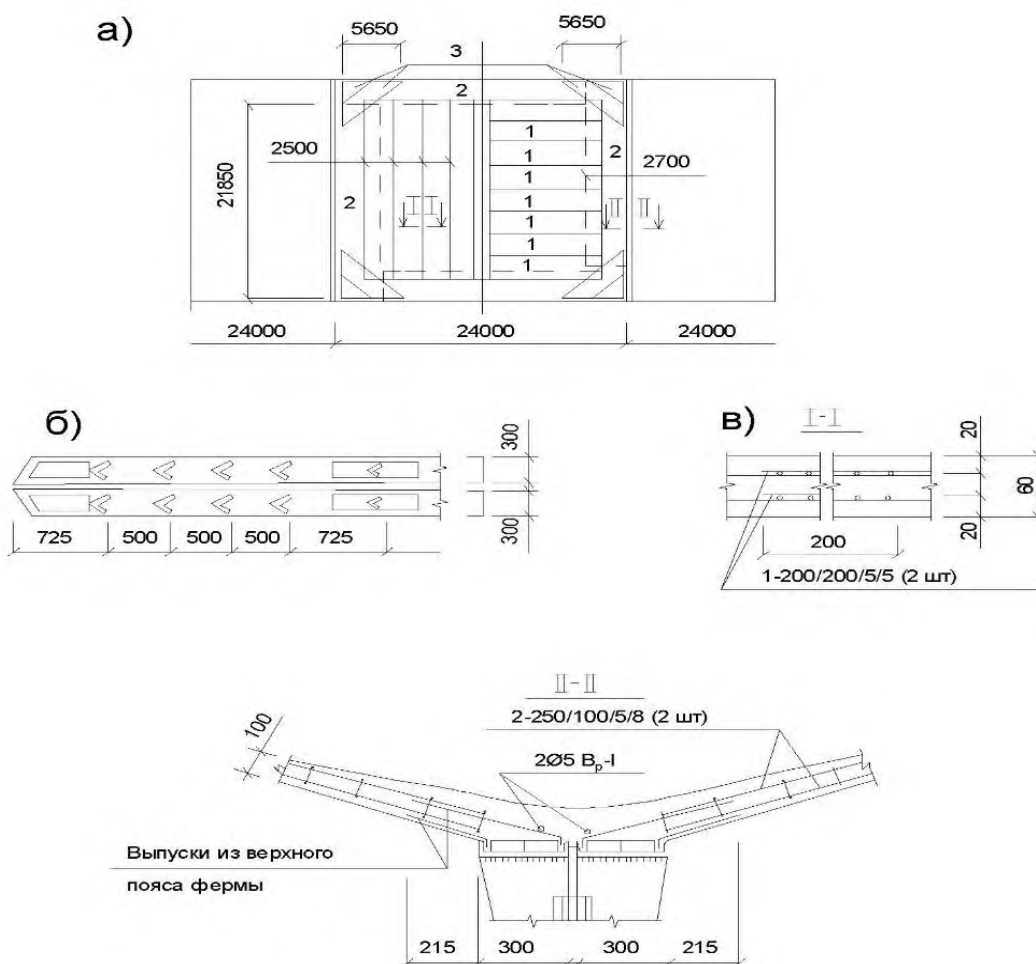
Конструкции естественных неразрезных пологих оболочек размерами 24 x 24 м каждая: а) схема армирования; б) конструкция верхнего пояса ферм –диафрагм двух смежных оболочек; в) армирование плиты поля оболочки; г) узел стыка плит двух оболочек с верхними поясами ферм-диафрагм; 1 – сетка плиты поля 200/200/5/5; и2 – сетки приконтурной полосы 250/100/5/8; 3 – угловая сетка; 4 – накладка 250x500x12 мм; 5 – тоже 250x600x12 мм; 6 – шпонка; 7 – прокладка; 8 – решётка фермы-диафрагмы; 9 – ферма-диафрагма; 10 – косынка
